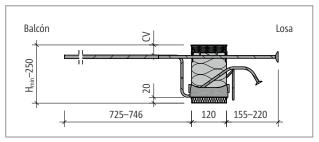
Schöck Isokorb® XT tipo K-U-M4: Sección del producto
